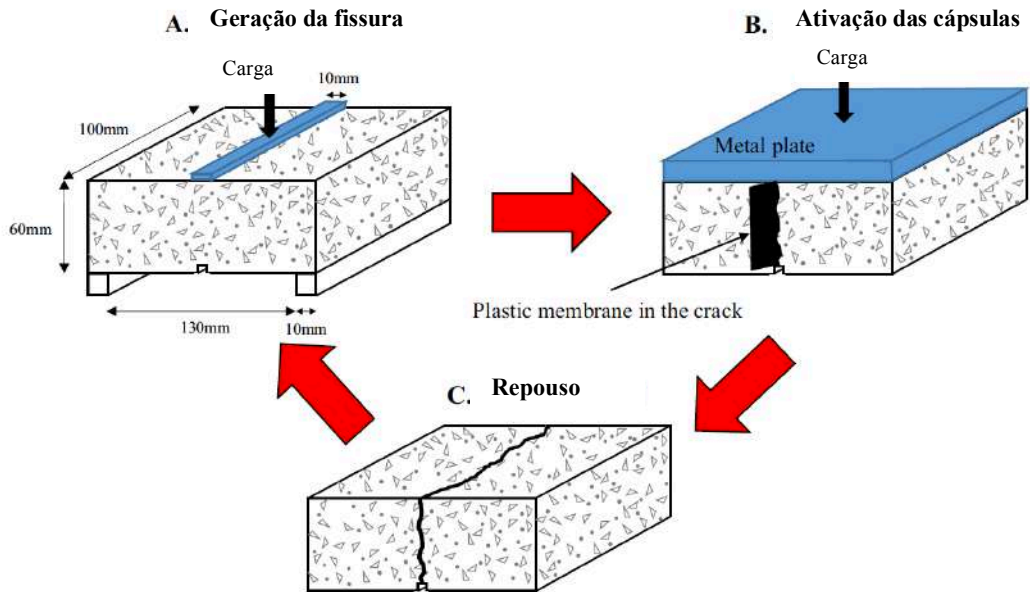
Esquema do ensaio de fissura - regeneração aplicado a uma laje (Al-Mansoori *et al.*, 2017)
